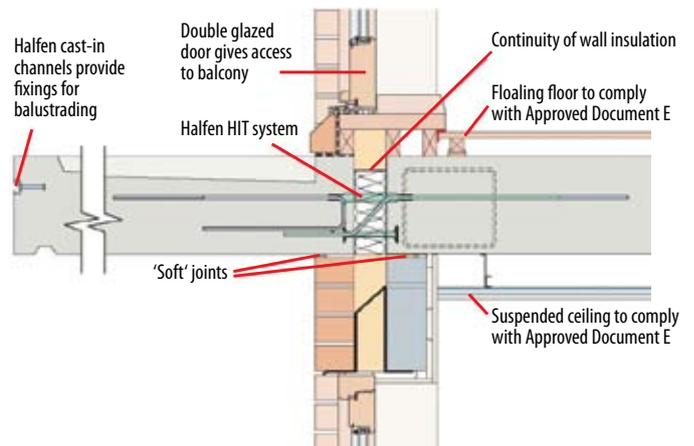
Теплоизолированное присоединение железобетонного балкона к междуэтажному перекрытию фирмы HALFEN DEHA предотвращает образование теплового моста
